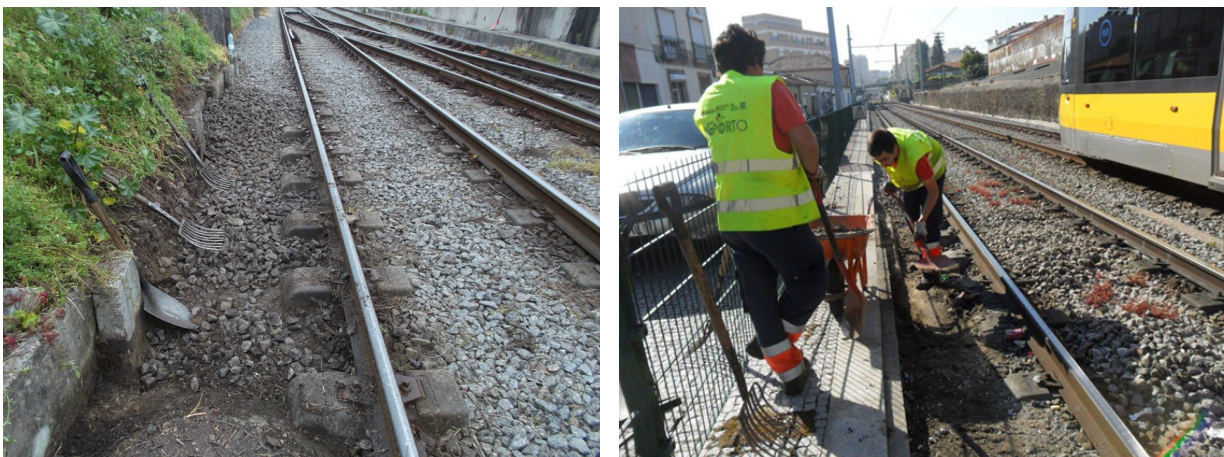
Zona de banqueta com balastro contaminado (esquerda) e depuração de balastro no Metro do
